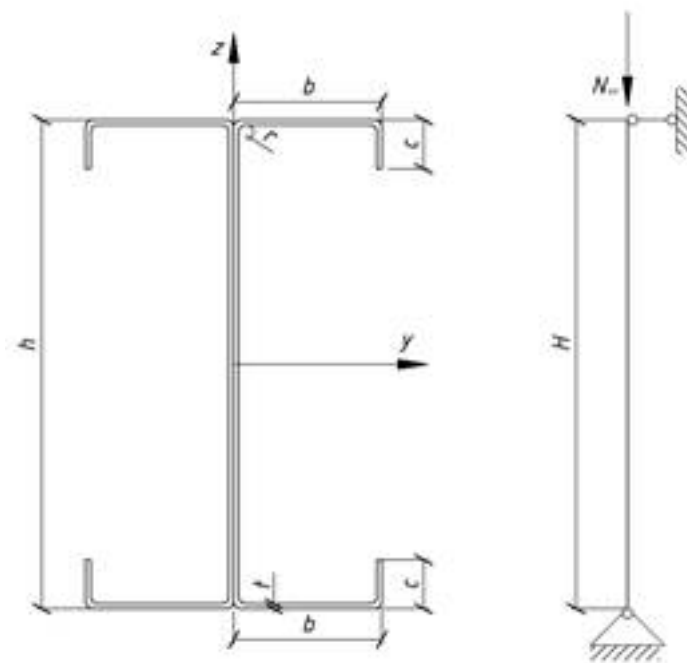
Расчетная схема и схема поперечного сечения стойки
